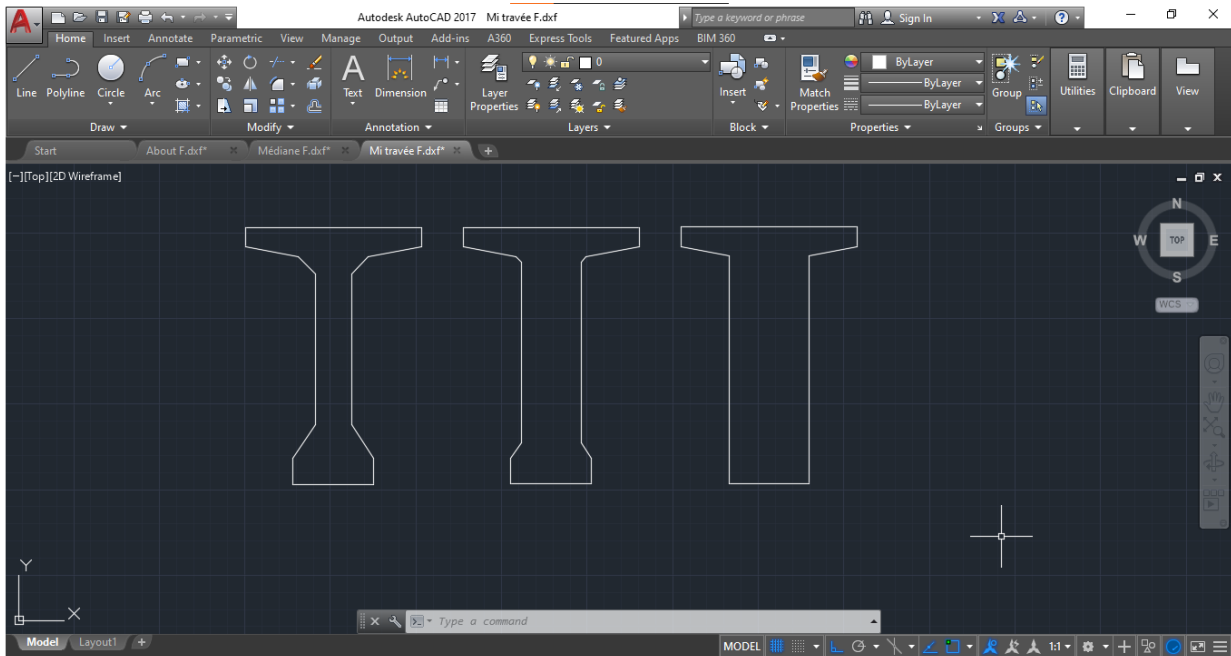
les différentes sections de la poutre (type SERO-EST)
